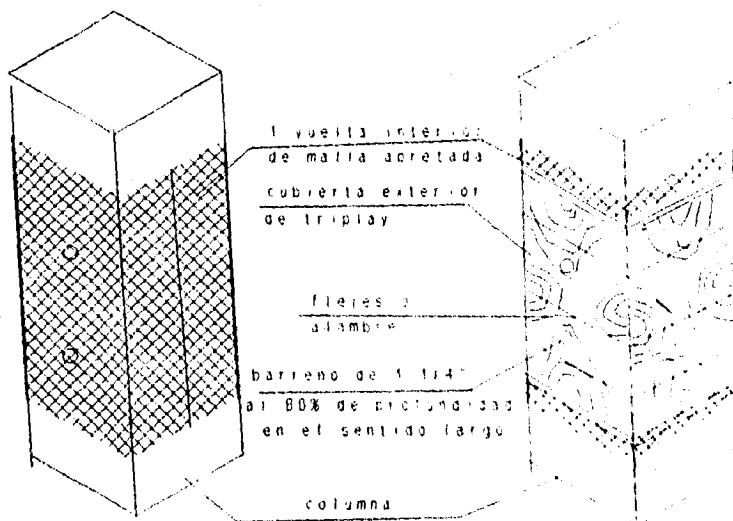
BARRENADO Y PROTECCIÓN EN COLUMNAS DE CONCRETO
